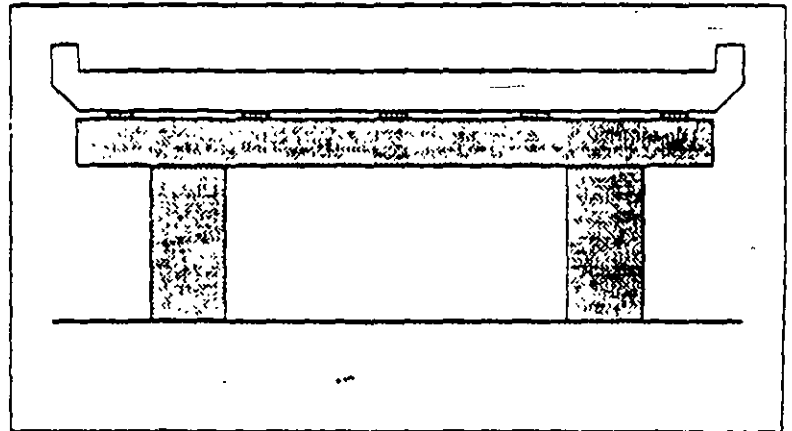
Pila, tipo 32, 2 o más columnas con cabezul común
